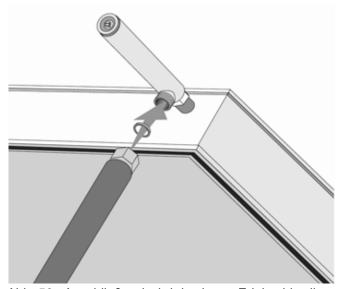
Anschließend wird das lange Edelstahlwellrohr (900 mm) mit dem T-Stück verbunden.
